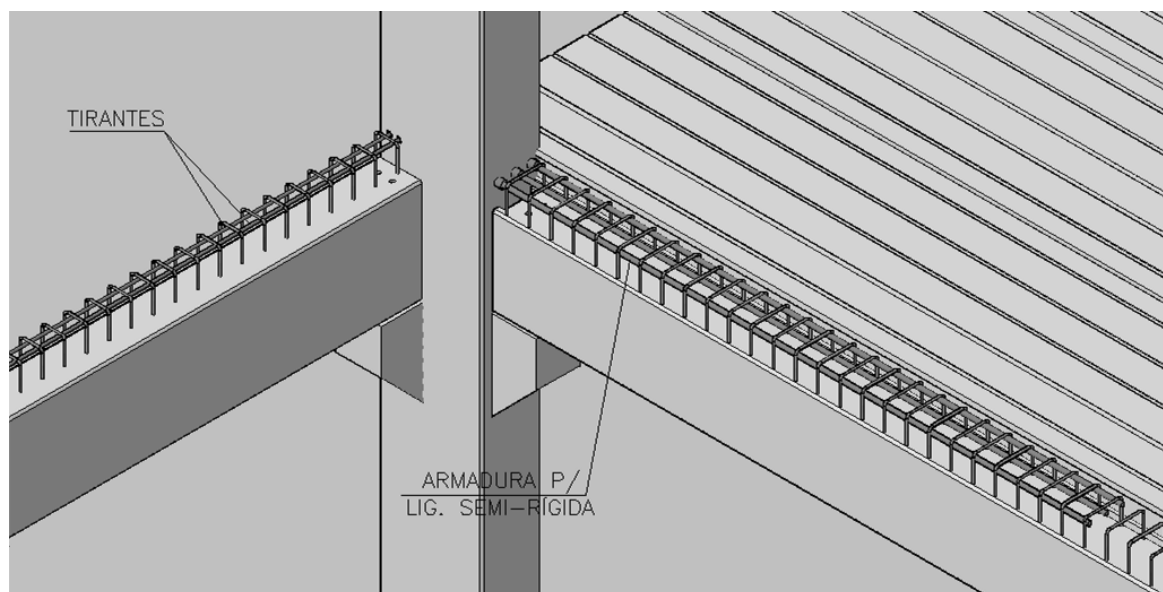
20 – Detalhe da ligação viga – pilar com armadura de continuidade da viga e barras do tirante.
